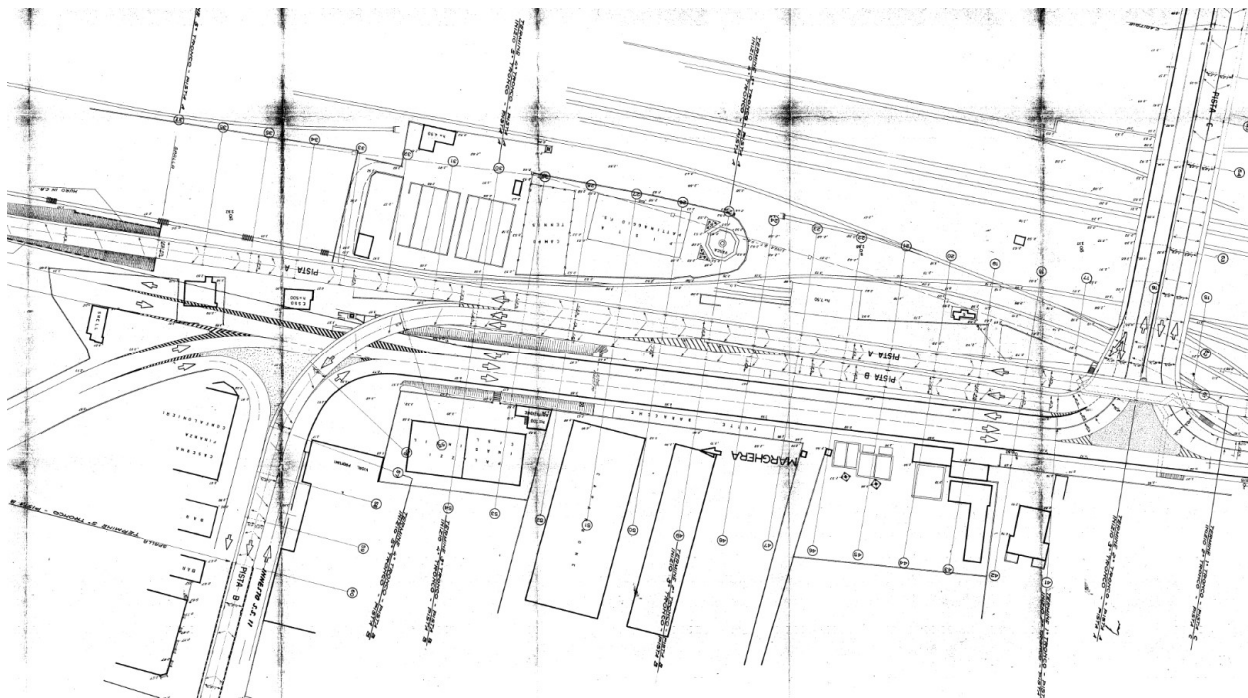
Planimetria generale PISTA A, PISTA B, PISTA C - 31.05.1967
